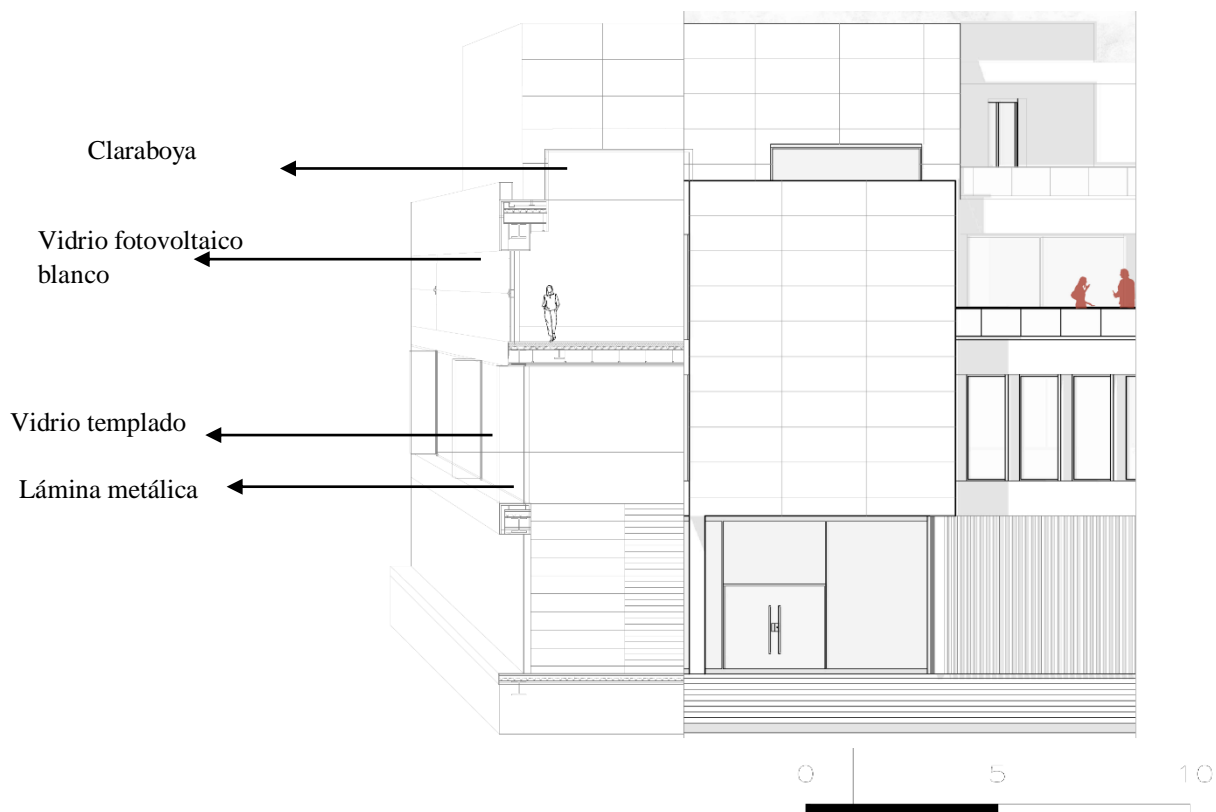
Corte a detalle por fachada usfq. Elaboración propia.
